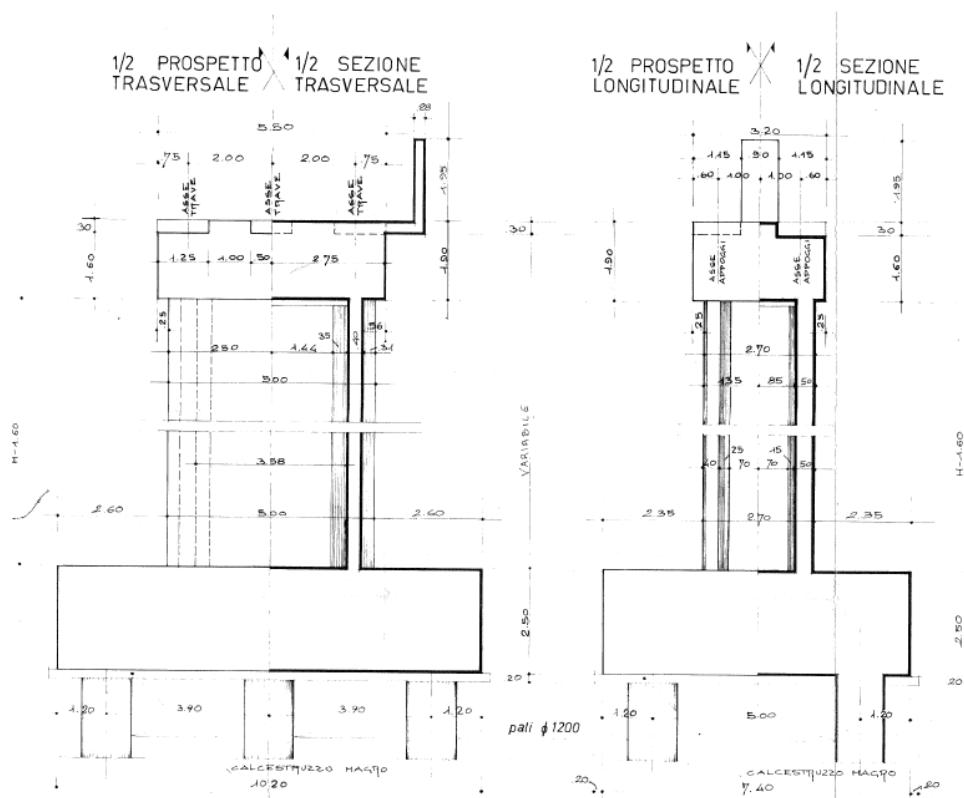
Prospetto Longitudinale e Trasversale Pila
